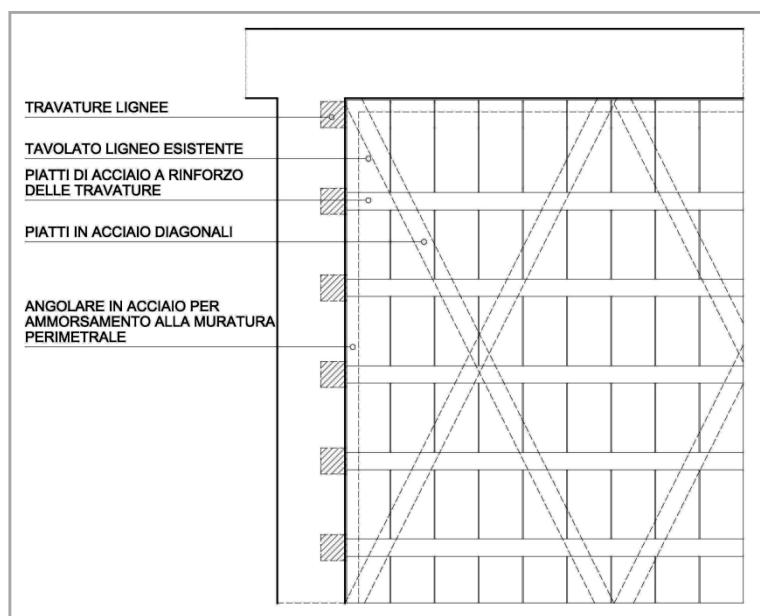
Vista in pianta solaio consolidato con piatti metallici.
